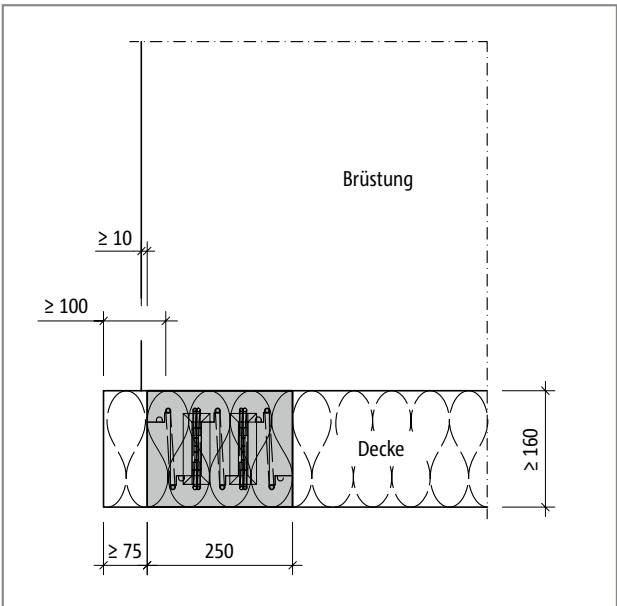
Schöck Isokorb® XT Typ AP horizontale Anordnung: Ansicht Randabstände
